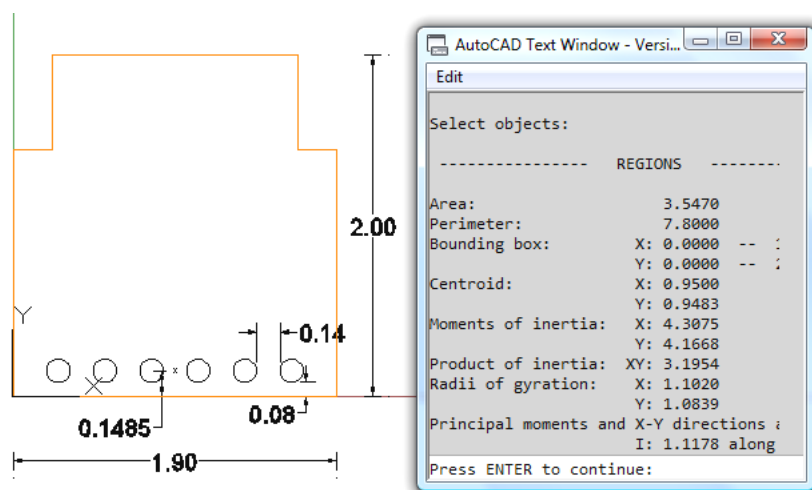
Características da secção transversal da viga B8 (AutoCAD)
